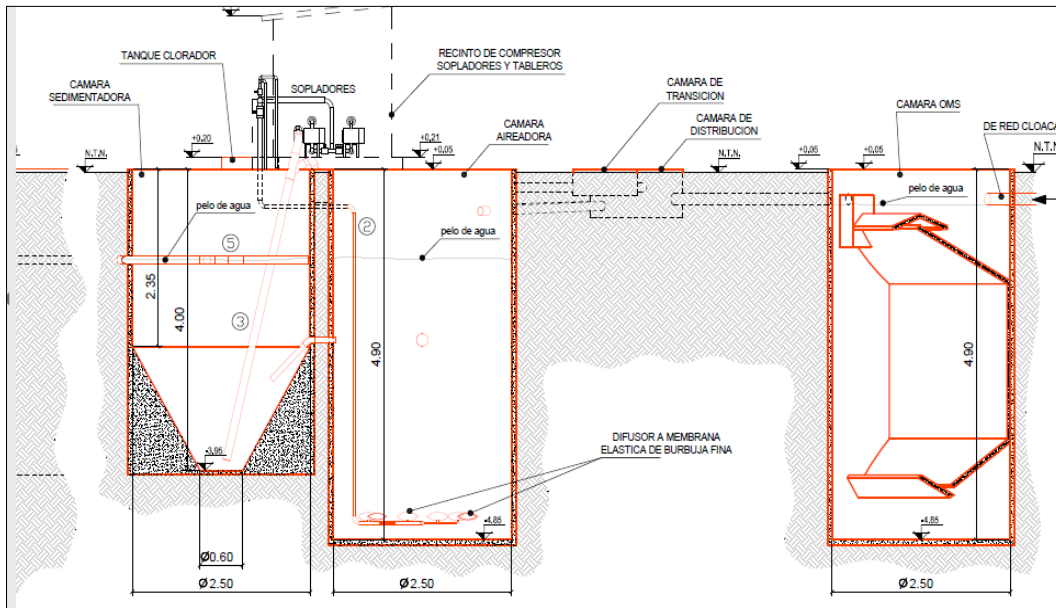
Vista en corte de la Planta de tratamiento de Líquidos Cloacales
